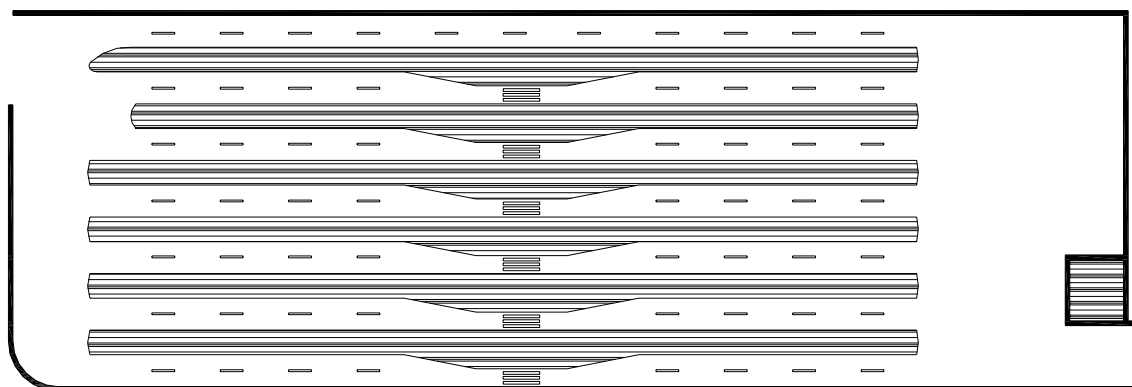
Layout simplificado da área de circulação dos veículos da Estação Barreiro
